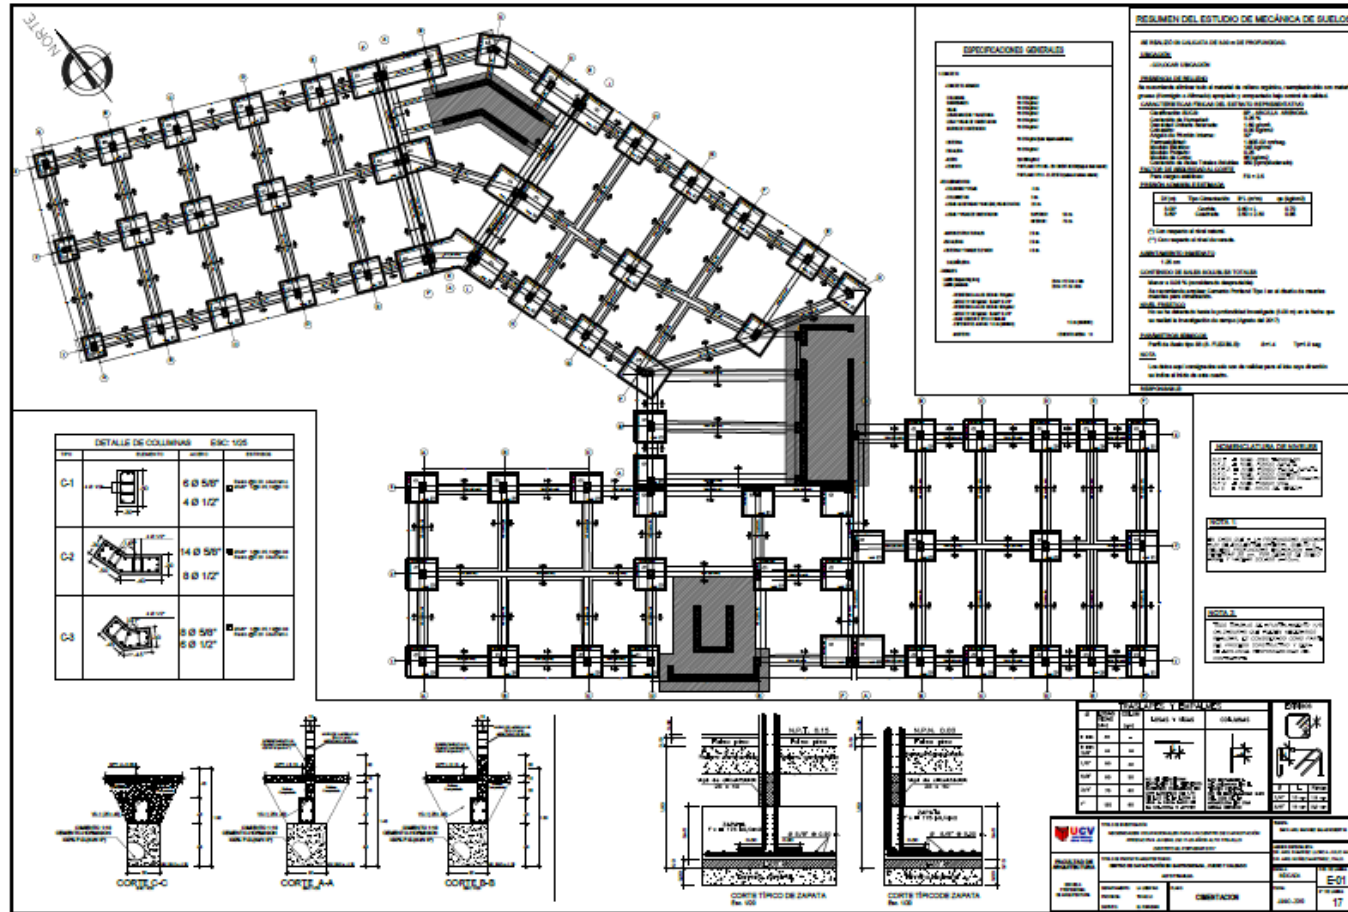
Plano de Cimentación-Plano N°17-Lámina C01
